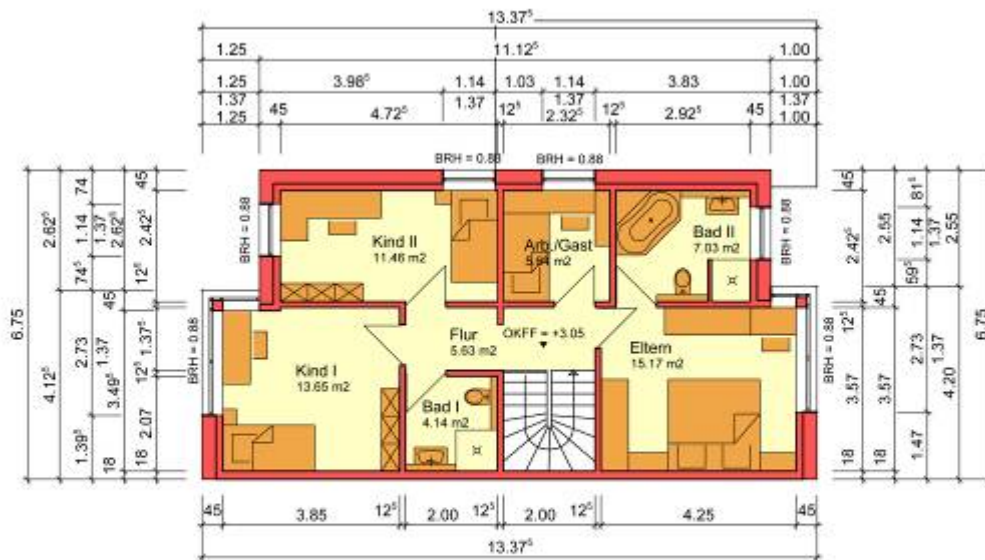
Obergeschoss Haustyp A (unmaßstäblich) Hillebrand und Welp
